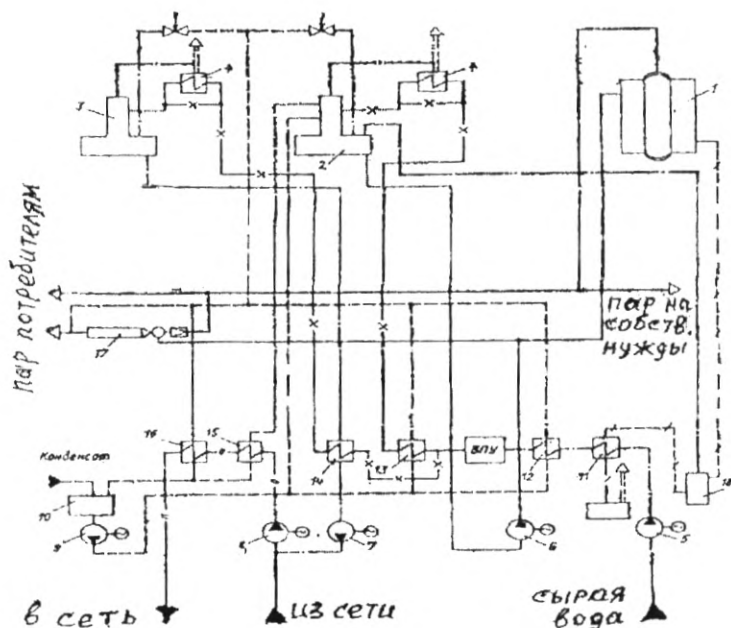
Принципиальная тепловая схема паровой котельной.
